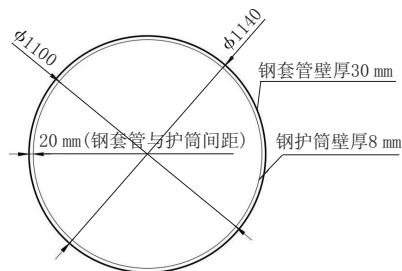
钢套管、钢护筒与污水管相对位置关系平面图(单位:mm)
